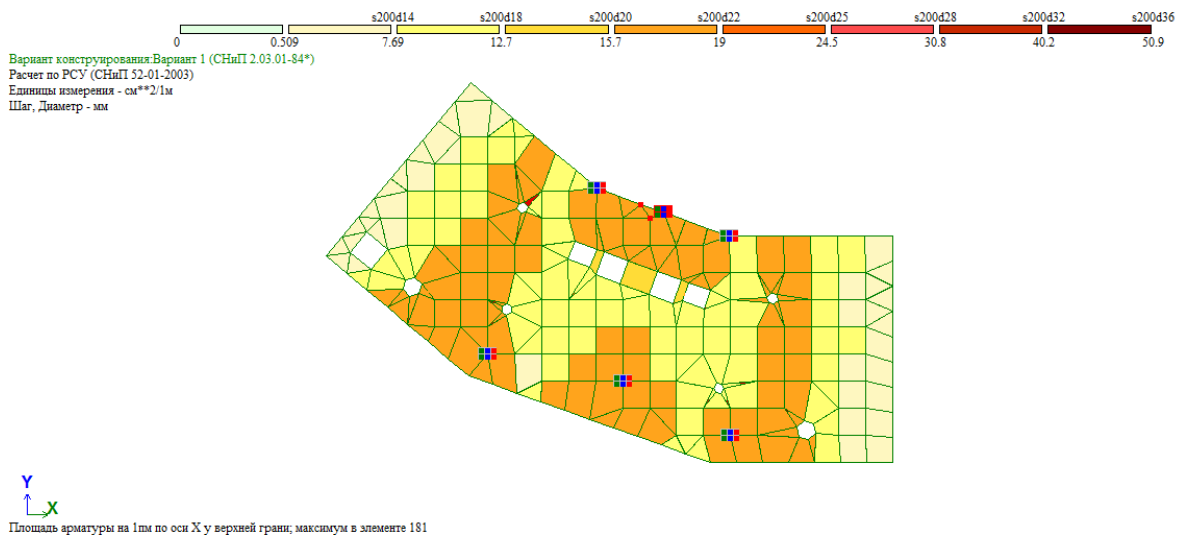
Площадь верхней арматуры вдоль буквенных осей
